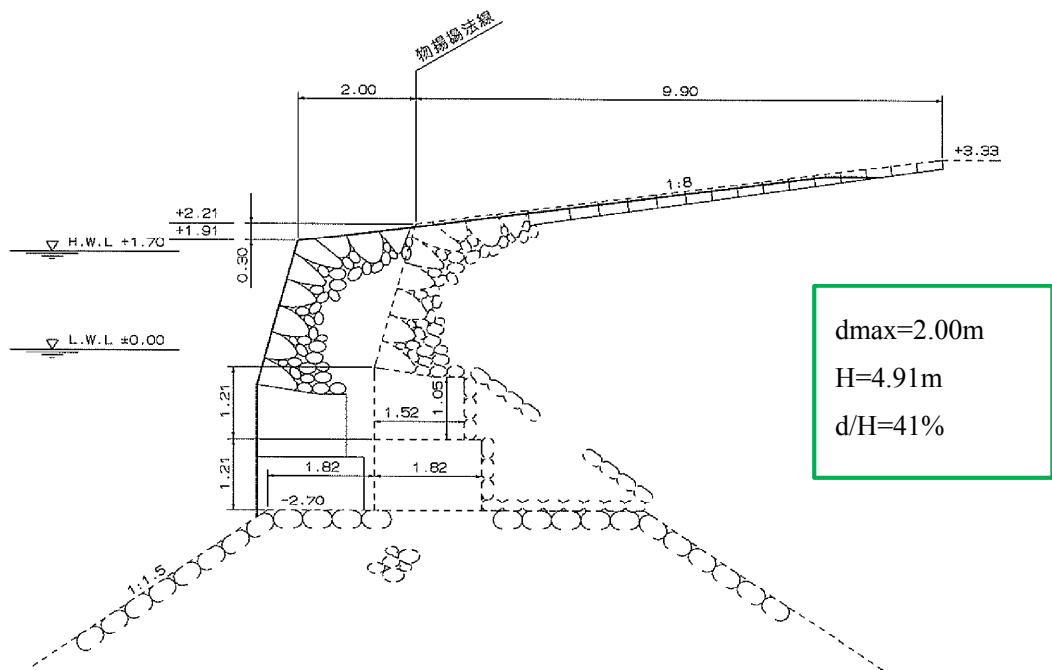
標準断面図, 被災状況断面図 (A-A) (新港西, ①第1突堤基部物揚場)
